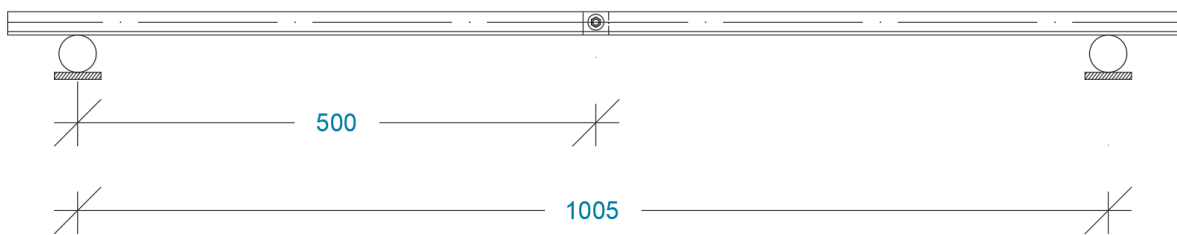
Esquema do ensaio da barra emendada simplesmente apoiada
